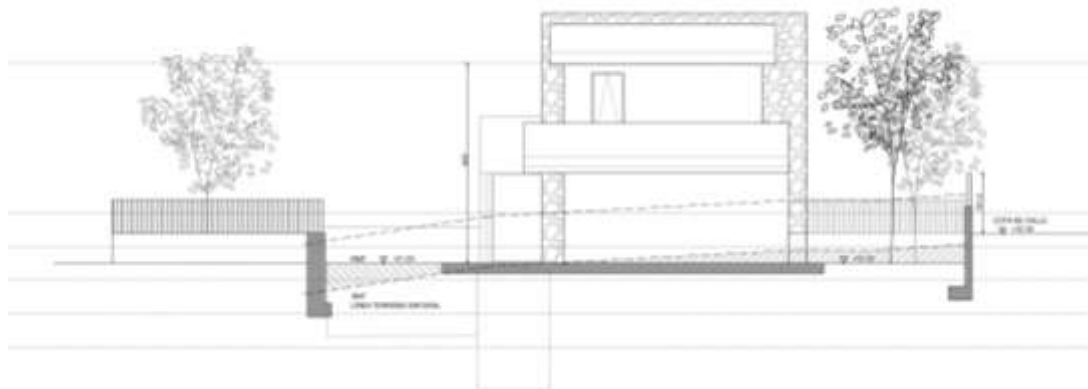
Alzado sureste. Fuente: proyecto básico y de ejecución.
